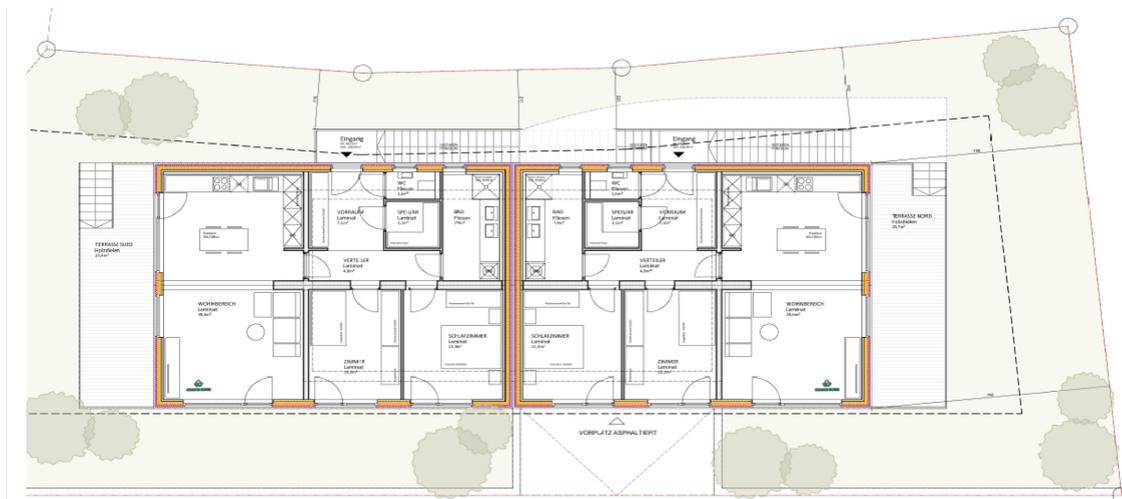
Grundriss 1. OG, COMMOD HOUSE vom 13.08.2021
